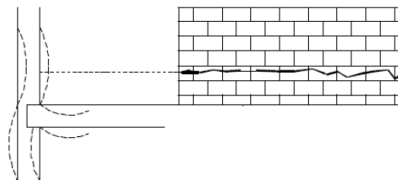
Fissuração Horizontal oriunda da expansão das lajes. [5]
